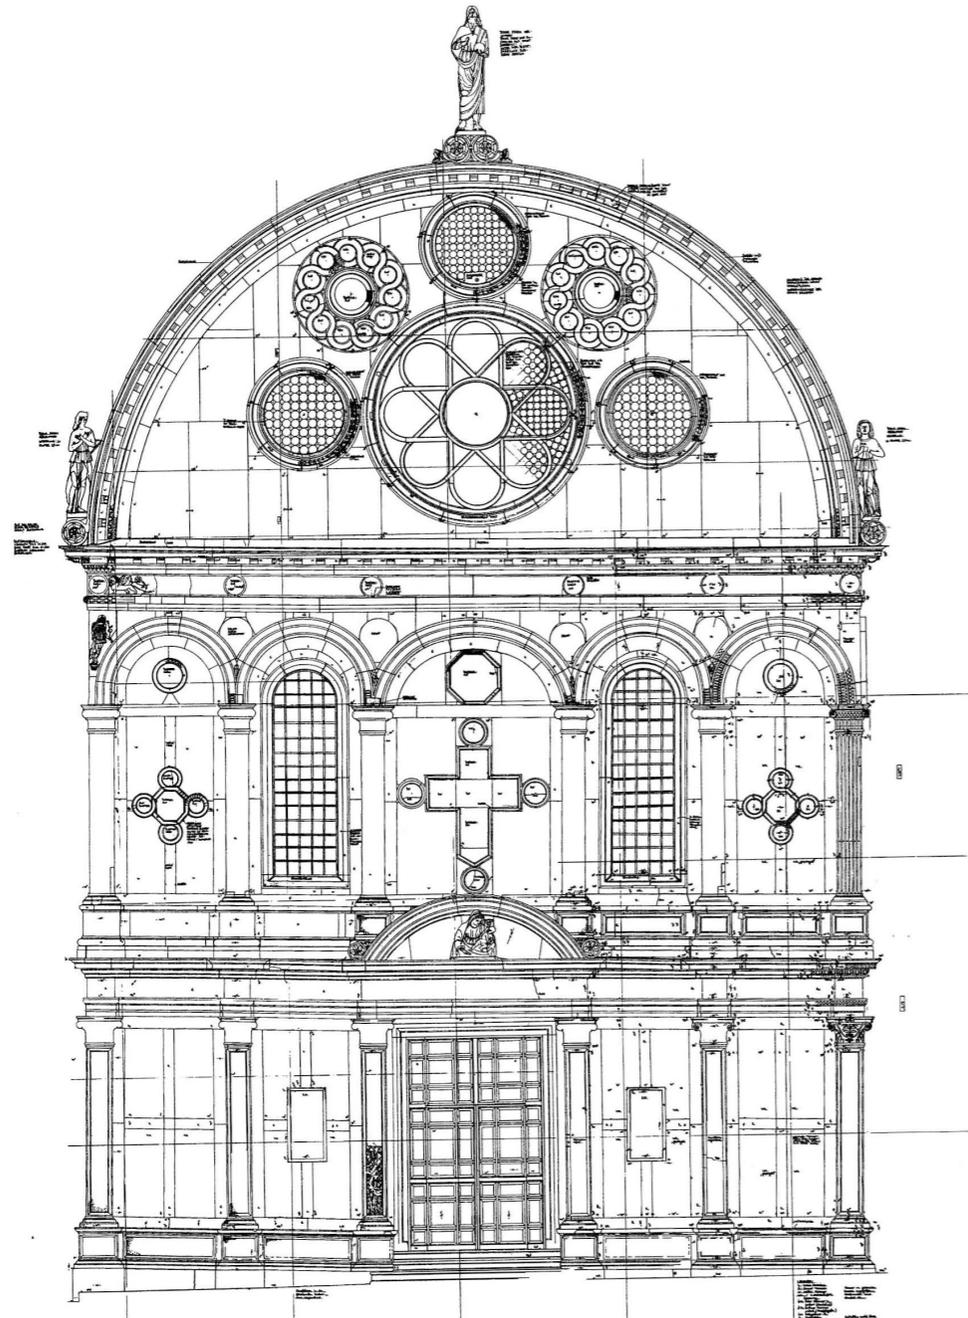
Facciata sud (R. Zahn, M. Zerbes, M. Bauer).
